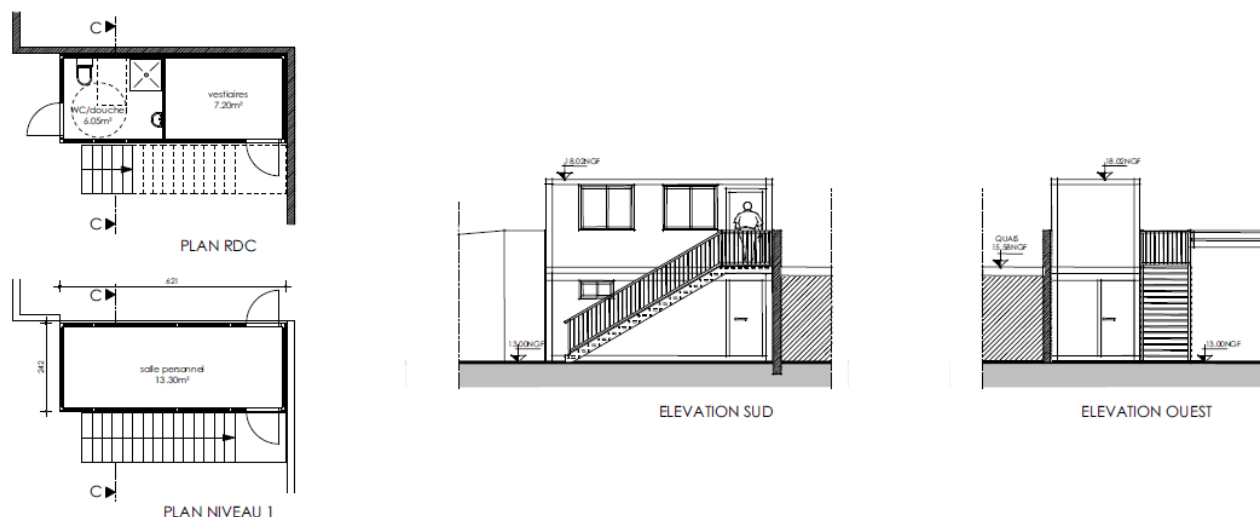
Plans et coupes du local du personnel (source : Agence d'architecture Escamez)
